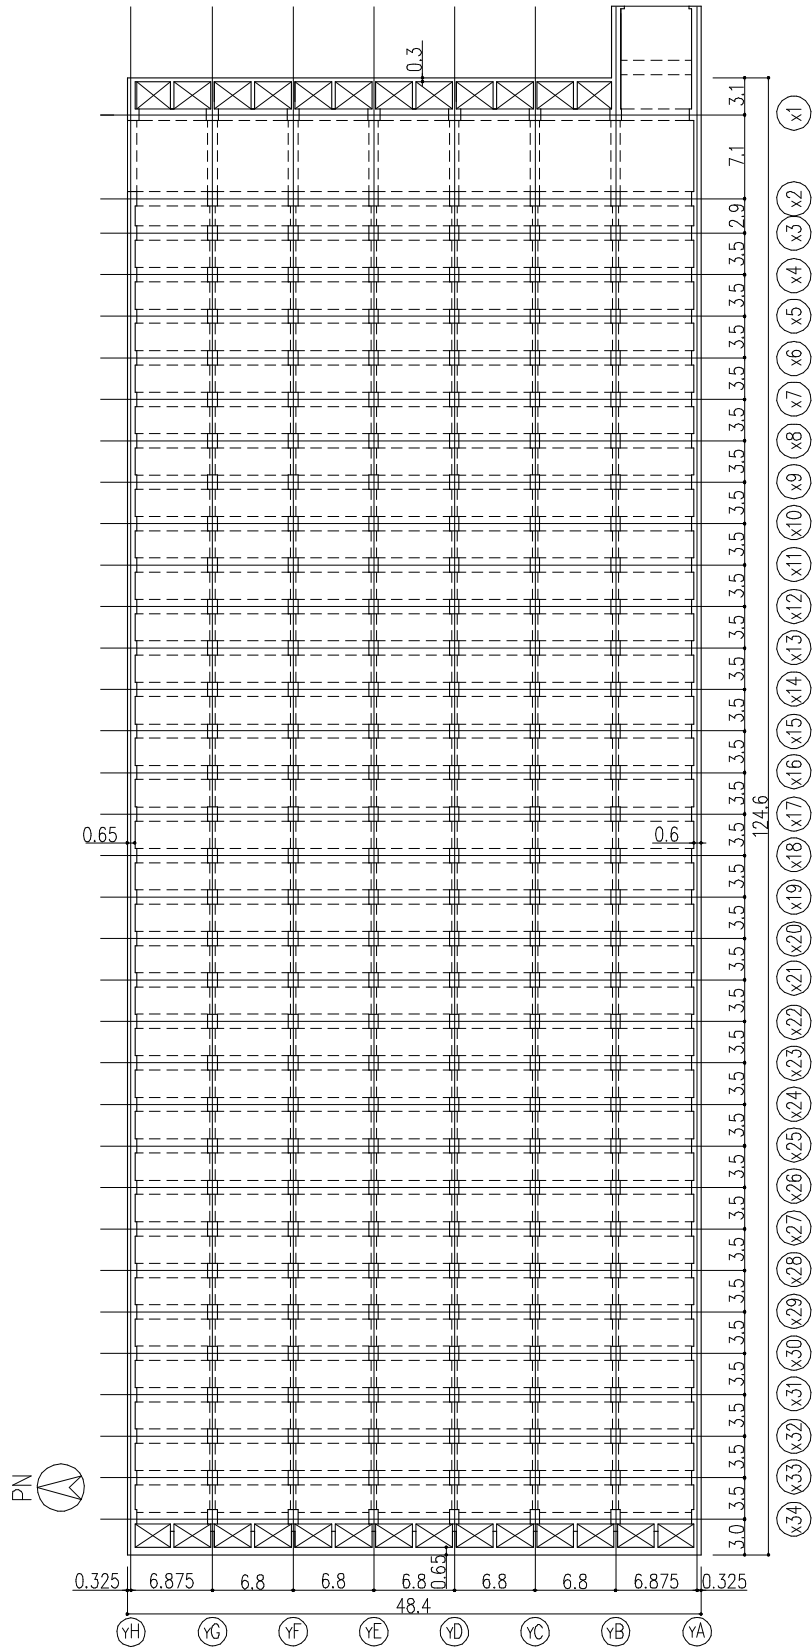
杭配置図 (G.L. -11.0) (单位 : m)
